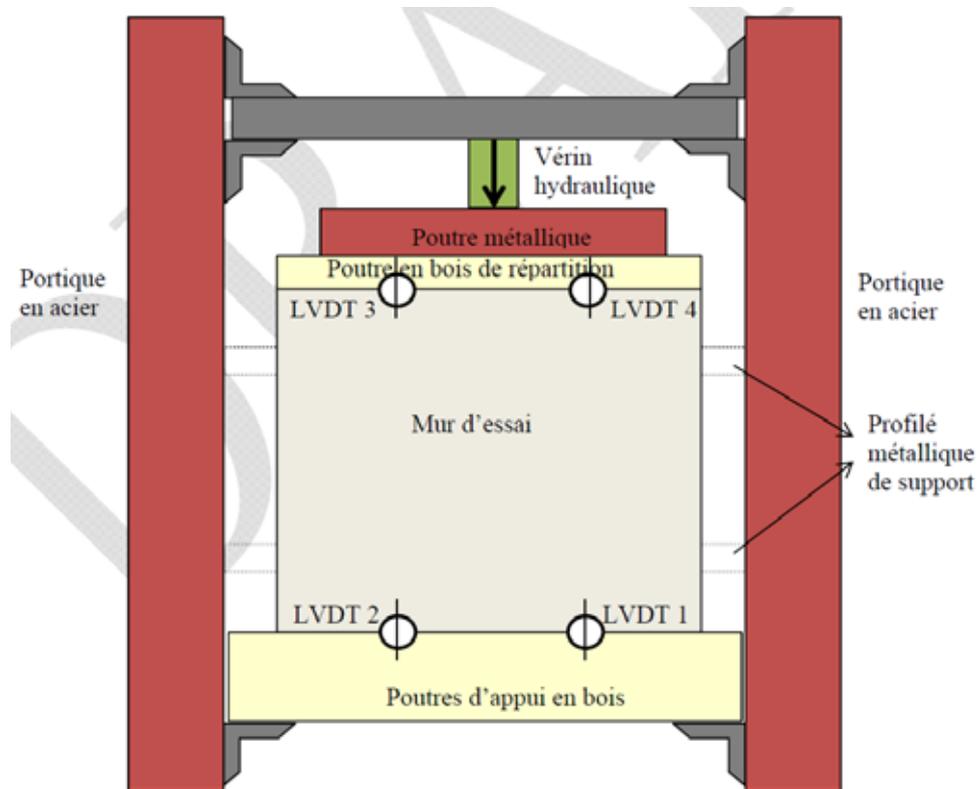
SCHÉMATISATION DU POSTE D'ESSAI DE COMPRESSION (VUE EN PLAN) [9]
